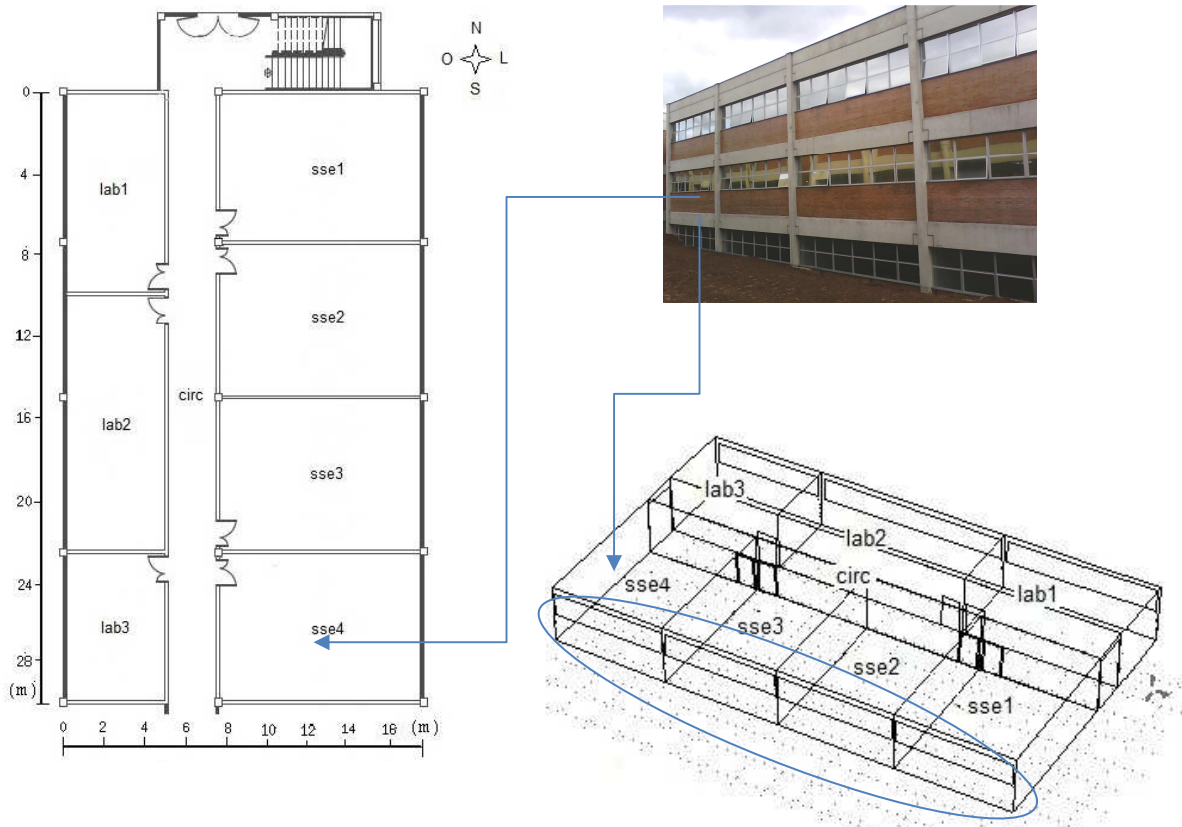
Foto da fachada leste, planta baixa e perspectiva geradas pelo ESP-r do Edifício II
